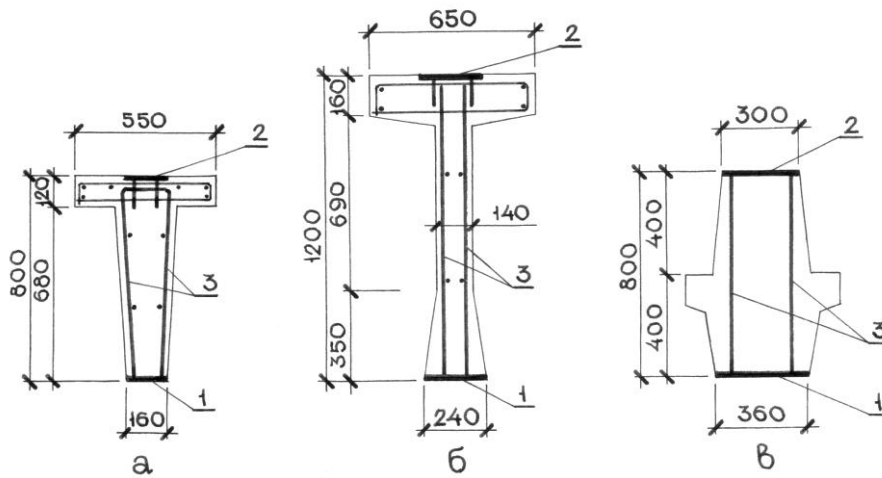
Конструкції сталевих залізобетонних балок і ригелів: а – підкранова балка прольотом 6 м; б – підкранова балка прольотом 12 м; в – нерозрізний ригель прольотом 12 м; 1 – розтягнута листовая арматура; 2 – стиснута листовая арматура; 3 – поперечна арматура.
